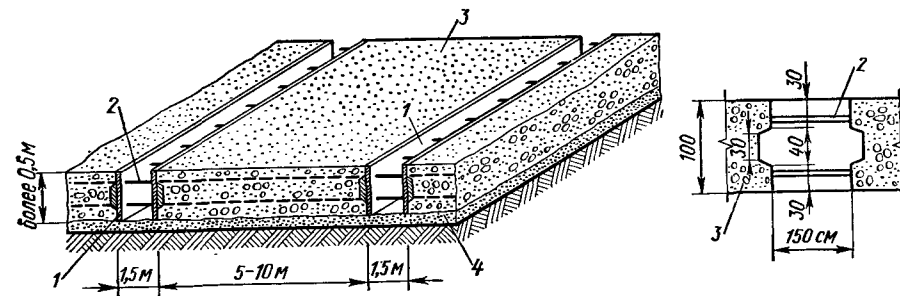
Бетонирование больших плит: 1 — опалубка разделительной полосы; 2 — арматура; 3 — бетон; 4 — подстилающий слой
